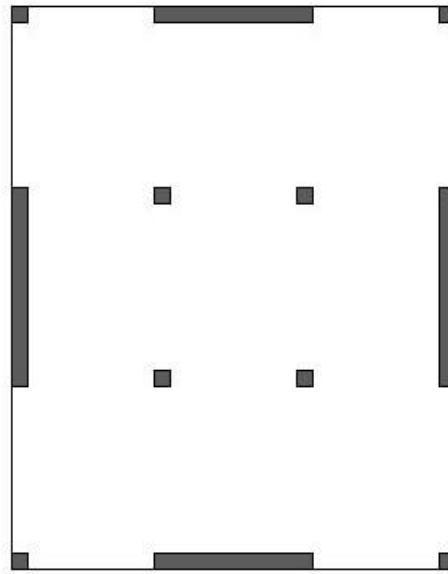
Exemplo de distribuição dos elementos estruturais verticais. (Sampaio, 1995)
